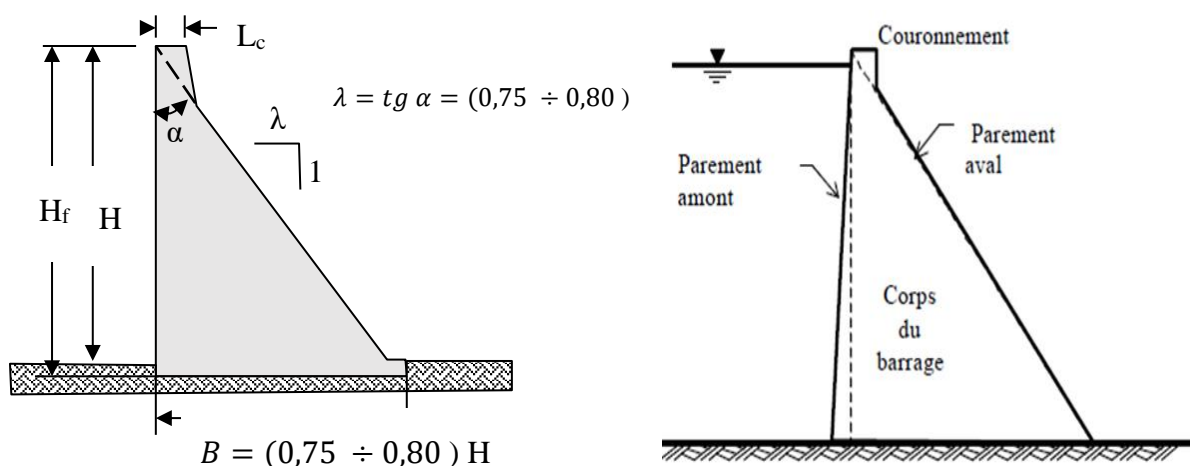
Profil type d'un barrage poids (Schleiss and Pougatsch, 2011)
